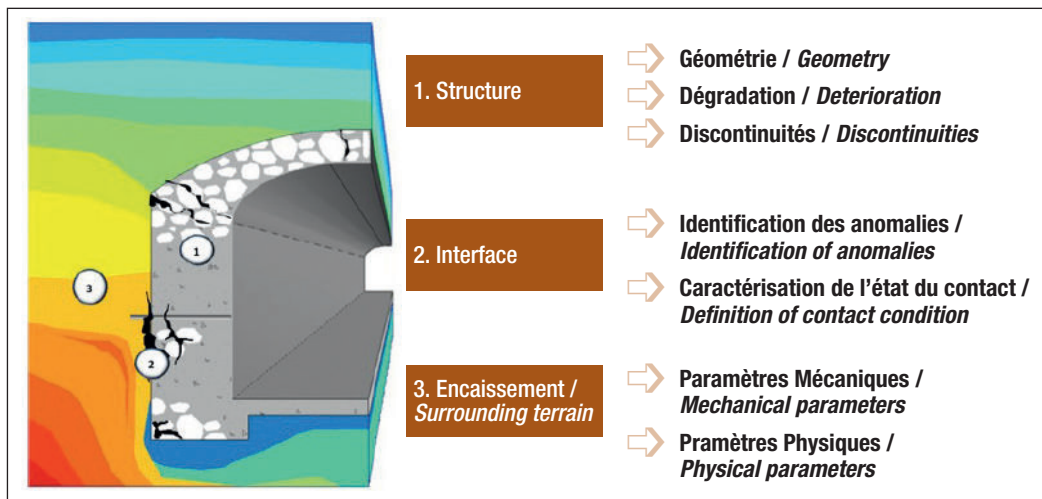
Coupe d'un tunnel type RATP (accès) / Cross-section of a typical RATP access tunnel.
